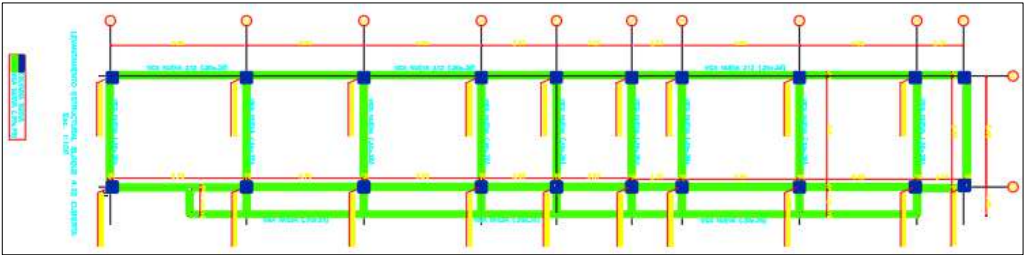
Esquema de distribución de vigas (verde) y columnas (azul) en el nivel de cubierta totalmente nuevo
